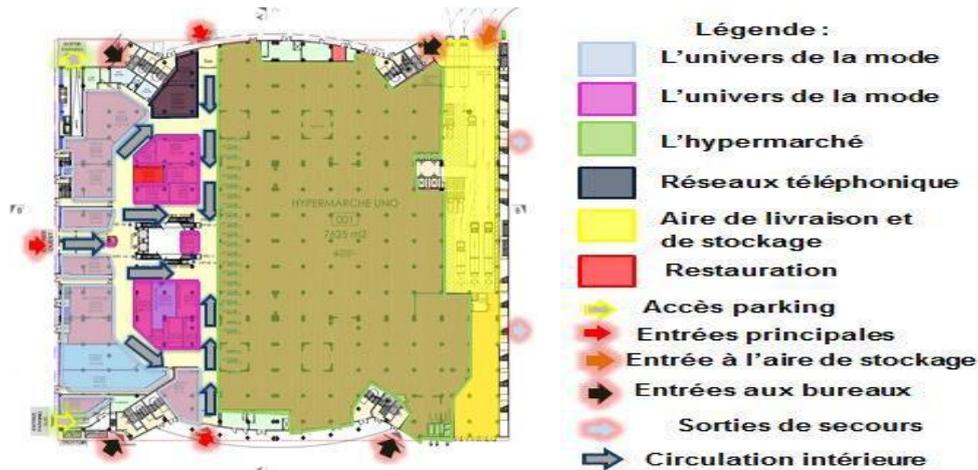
Vue en plan du RDC du centre commercial de Bab Ezzouar.
